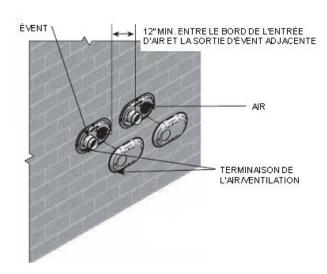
Dégagements minimaux : Terminaisons murales multiples
